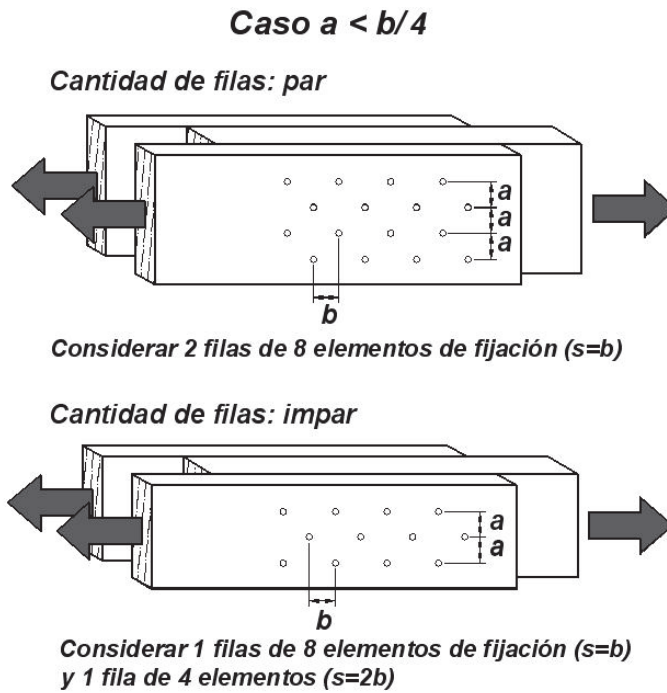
Acción de grupo en miembros cargados paralelamente a la dirección de las fibras y unidos con elementos de fijación colocados en tresbolillo.
